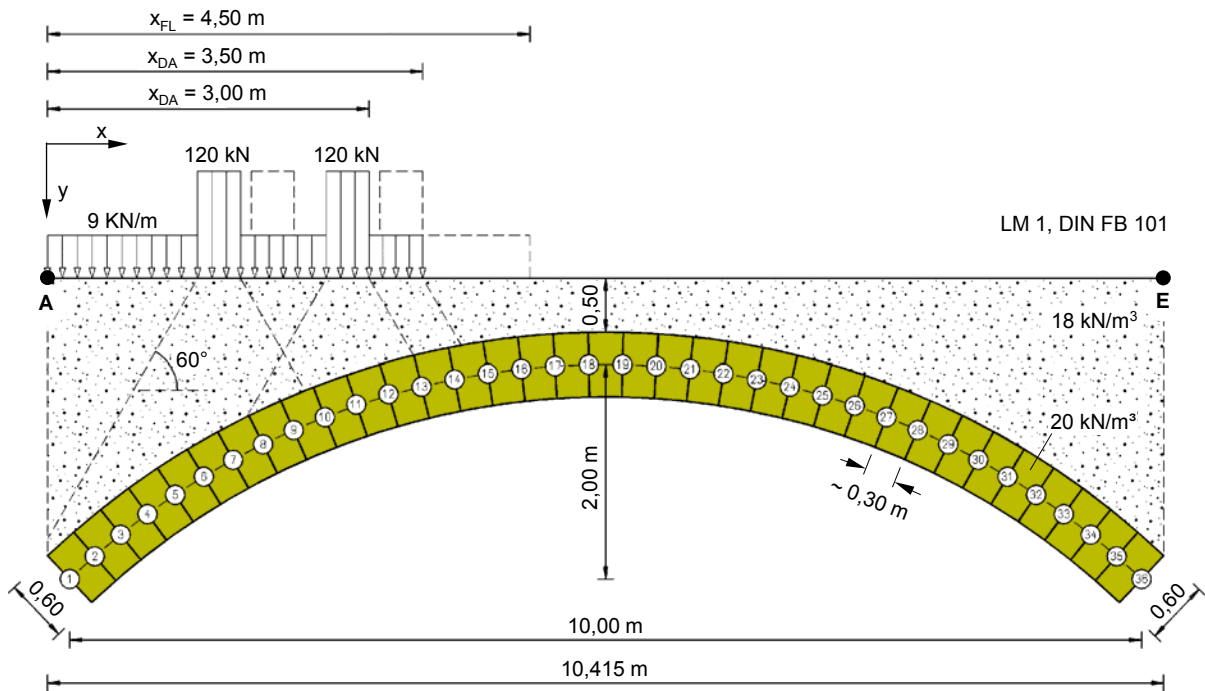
Standardbrücke mit ungünstigen Laststellungen
